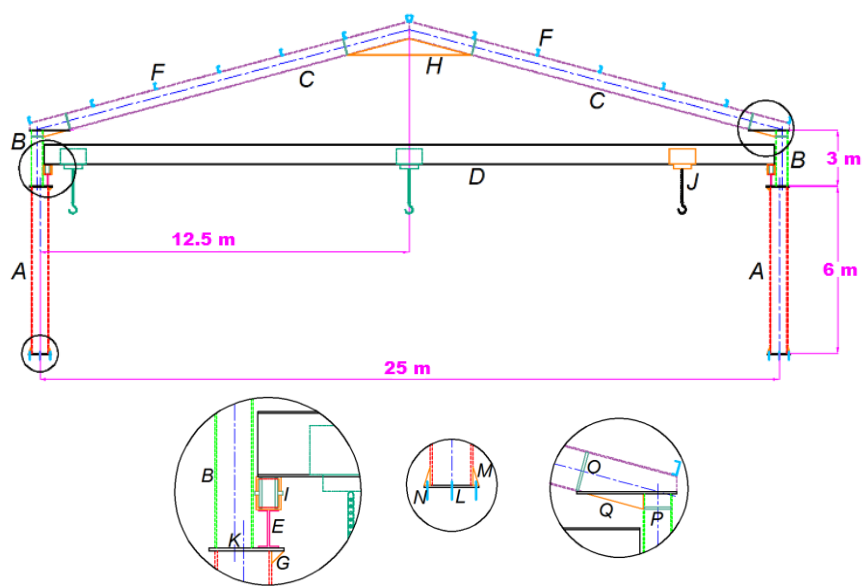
Esquema detallado de la nave industrial tipo puente grúa.
